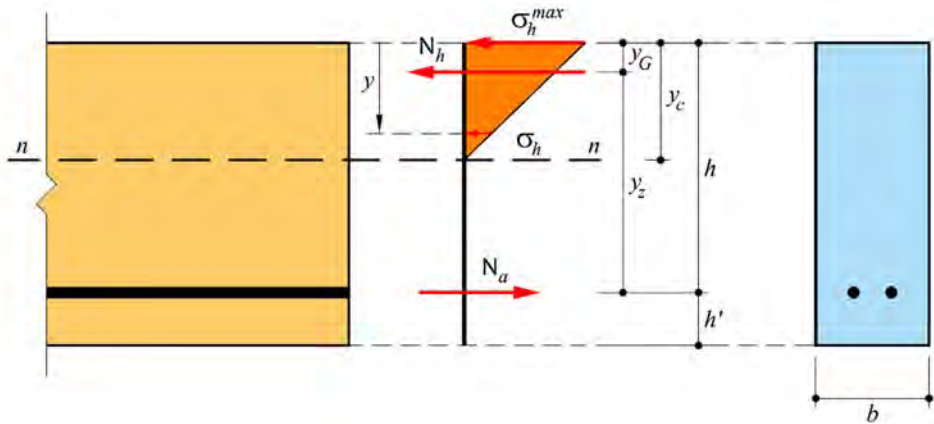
Pieza de hormigón armado sometida a flexión pura recta.
